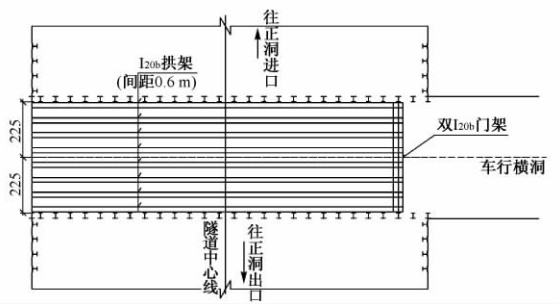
导洞入口端拱架焊接门架平面布置(单位: cm)
